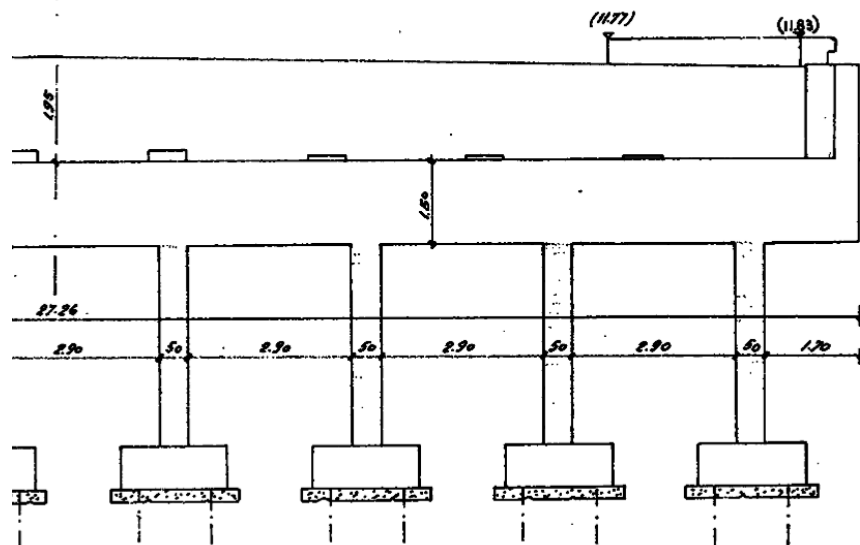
Semi-prospetto spalla esistente
